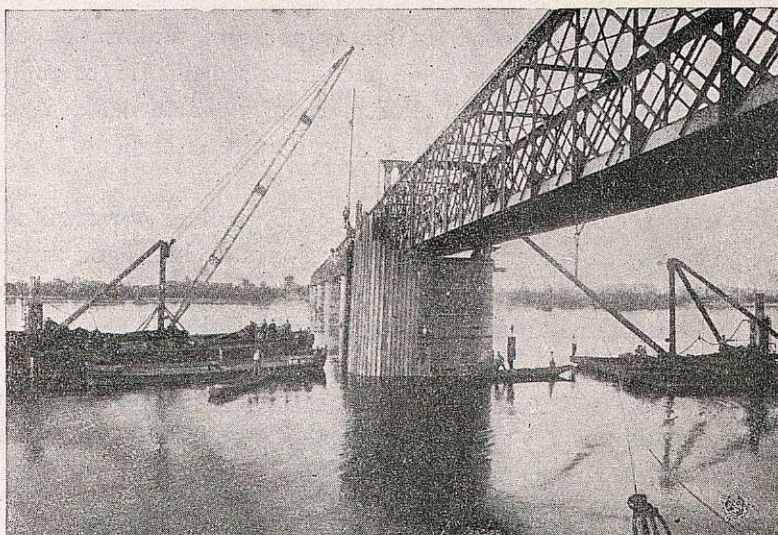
Reparación y defensa de las pilas con tablestacas metálicas
